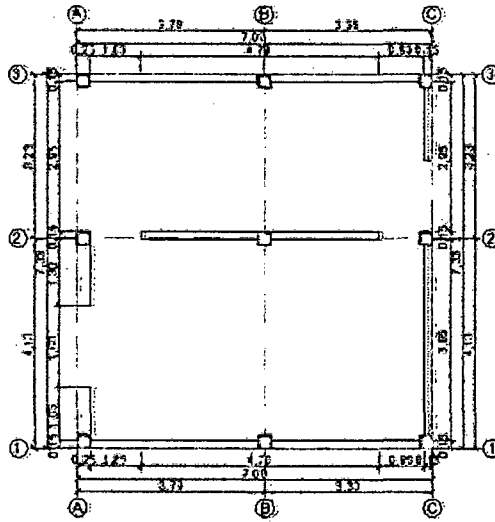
Plano de arquitectura de la planta típica de la Vivienda AHSL24.
